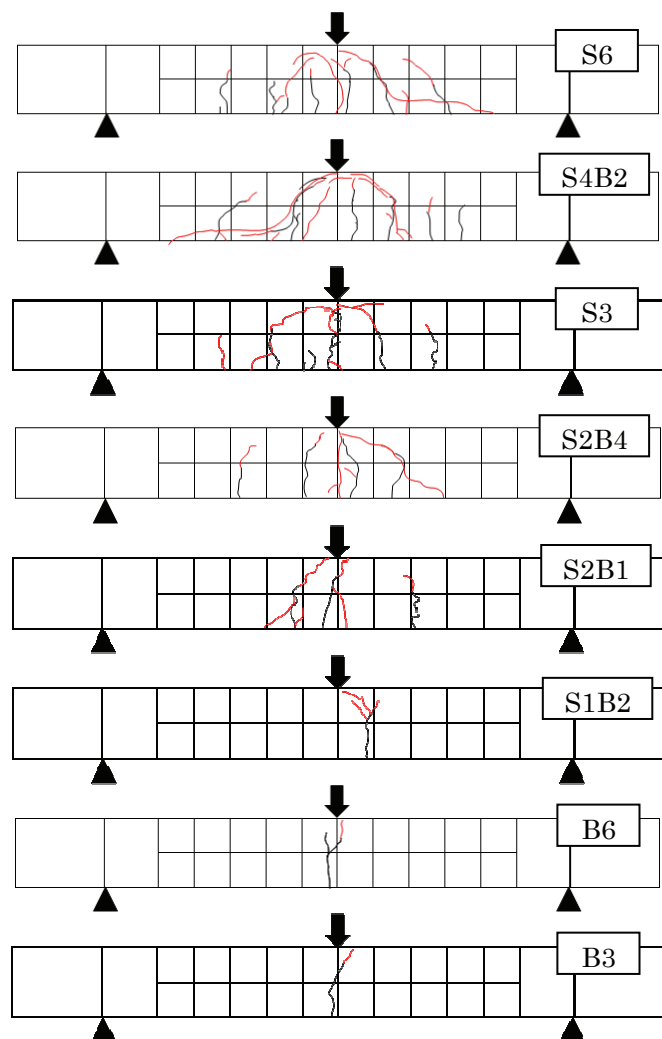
各試験体の実験終了時のひび割れ状況
